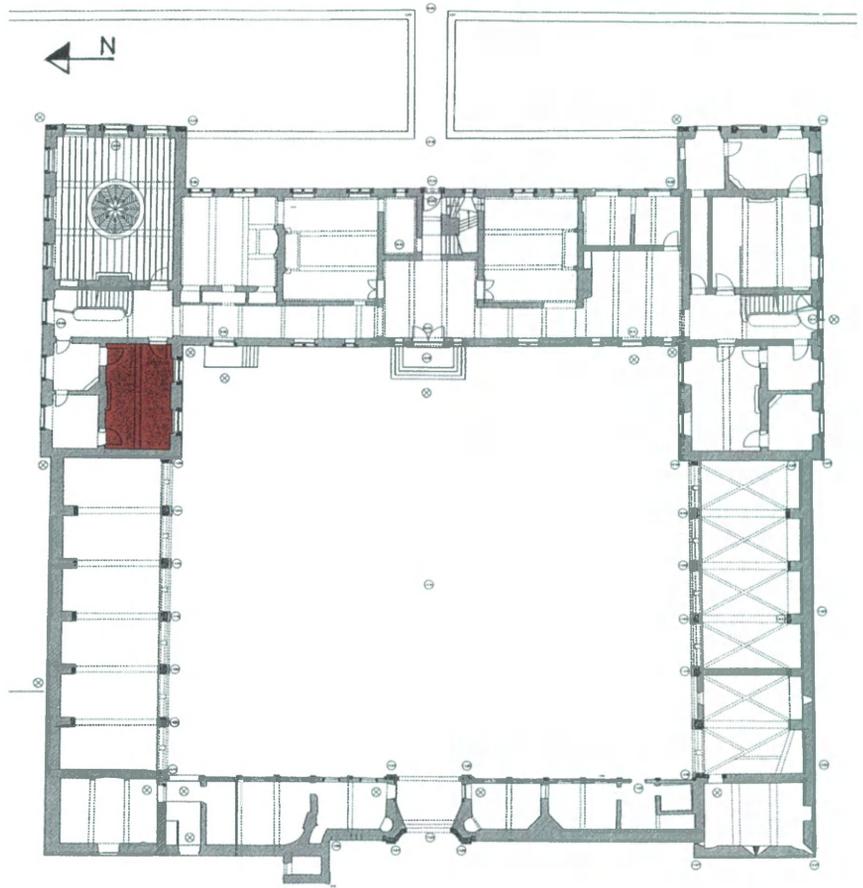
Plan du rez-de-chaussée du château. Localisation du salon d'honneur dit « salle d'armes » en brun.
